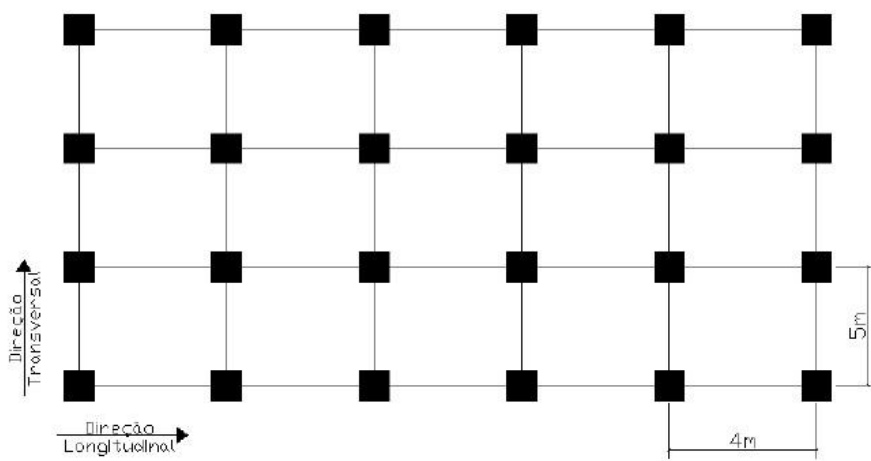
Disposição em planta do Edifício PT6 e indicação dos pórticos estudados (Furtado, 2013).
